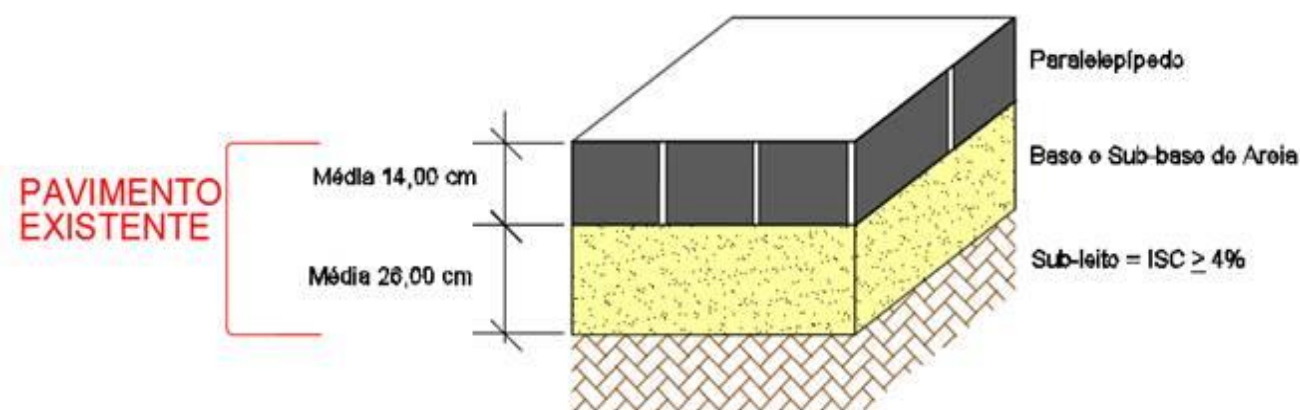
Seção do Pavimento Existente para o segmento 01, 03, 04 e 05
